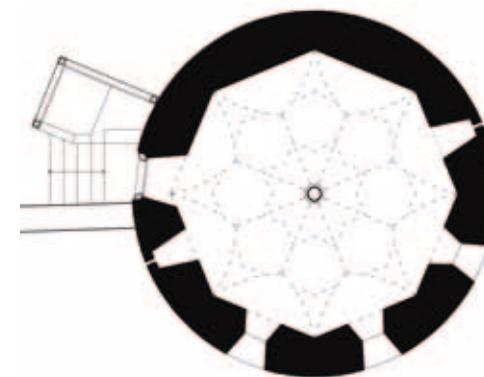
Grundriss des Karners in Altenmarkt, M 1:200. CA 2013.
